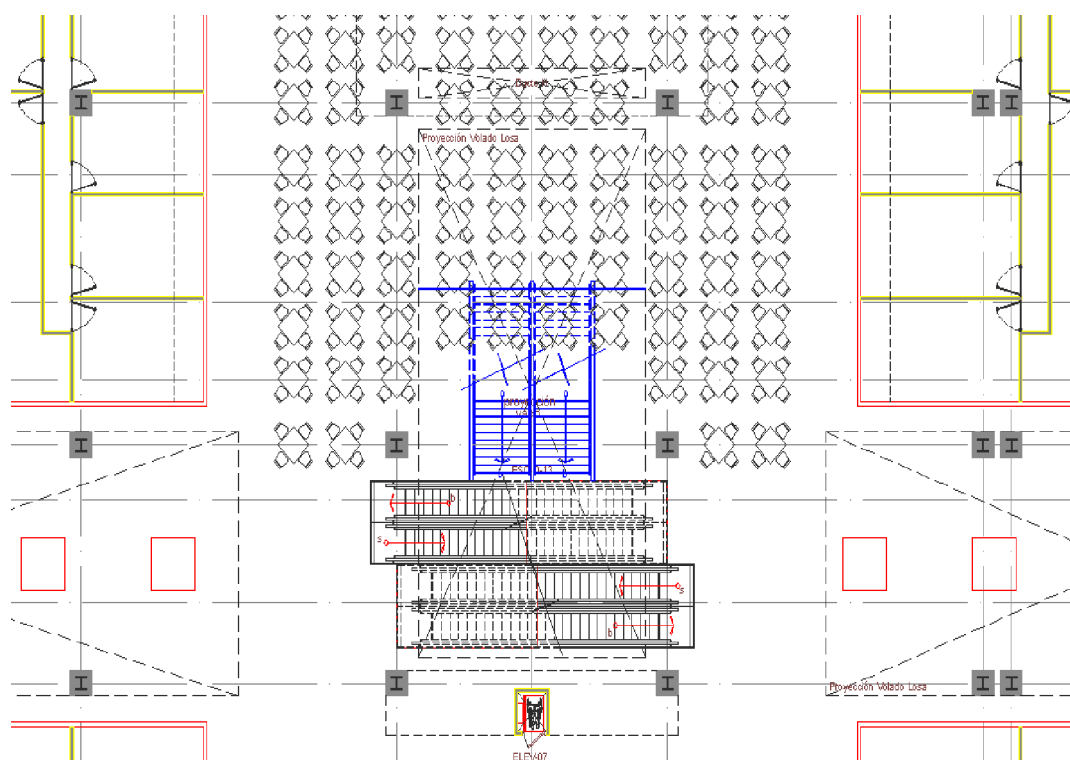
Nuevas escaleras fijas en el paradero oriente sobre el plano de +5.70 metros.
